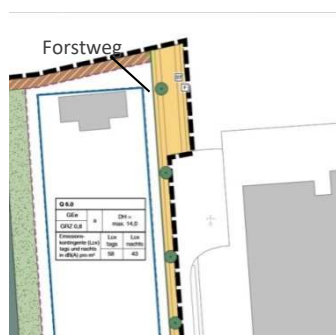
Teilausschnitt Bebauungsplan Gewerbepark Frauenwald II, 2. Änderung
